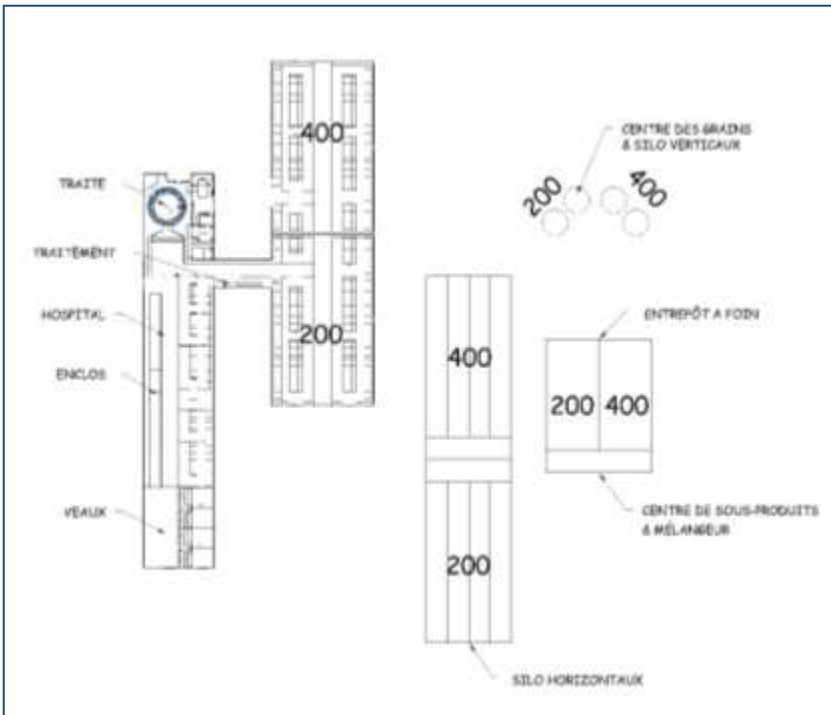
Développement d'une ferme de 200 à 400 vaches
